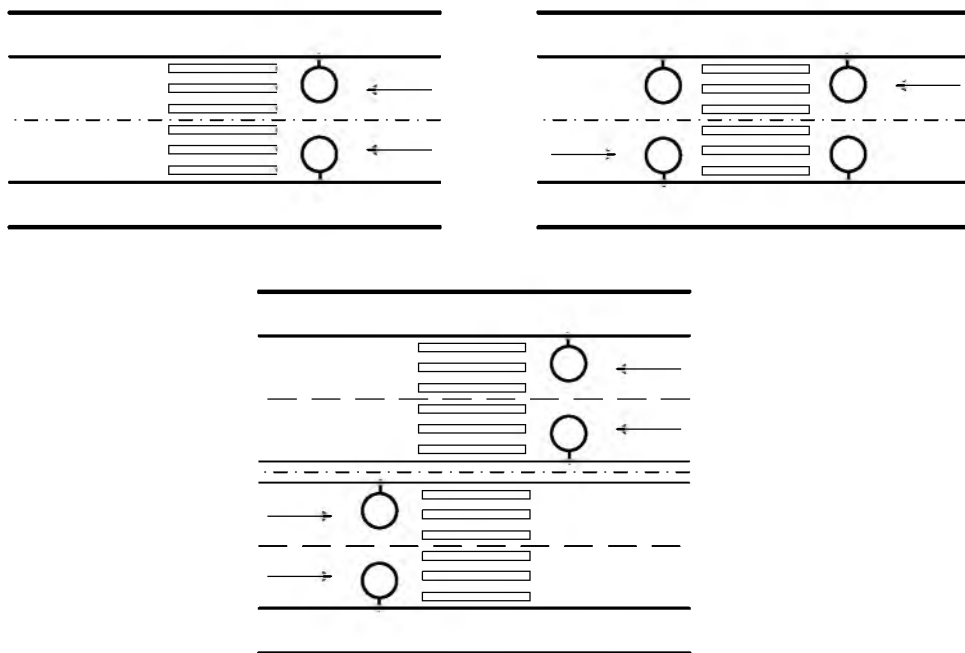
Схемы расположения светильников на пешеходных переходах
